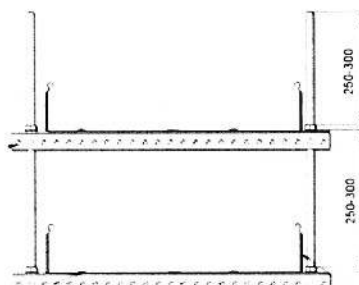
Вид подвеса (1 – П-образный профиль ВРМ; 2 – кабельный лоток; 3 – место крепления лотка к профилю).
